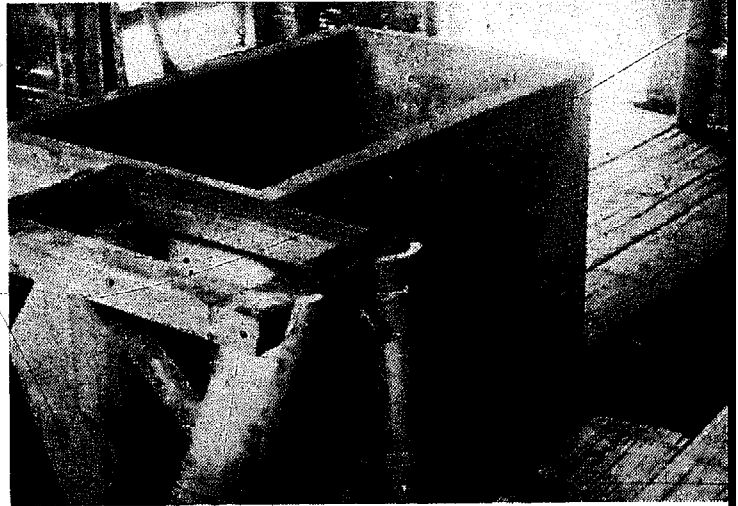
Ensayo de canastas recubiertas con mortero solo interlamente.
